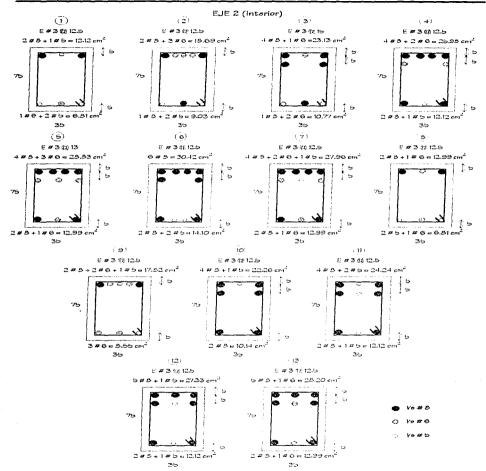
Tipos de armados de vigas del eje 2, edificio de 7 niveles diseñado en la zona il
